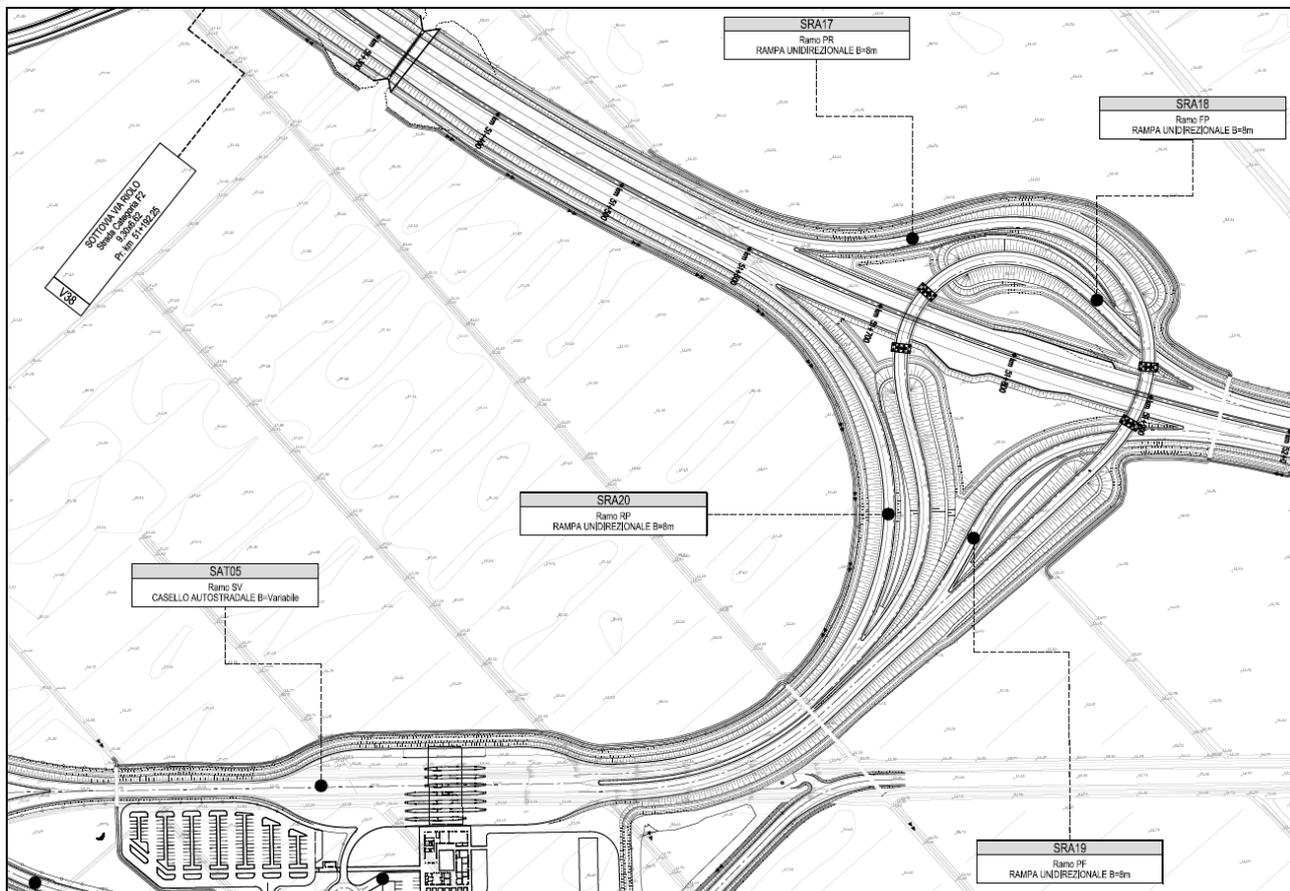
SCHEMA PLANIMETRICO SVINCOLO DI POGGIO RENATICO
